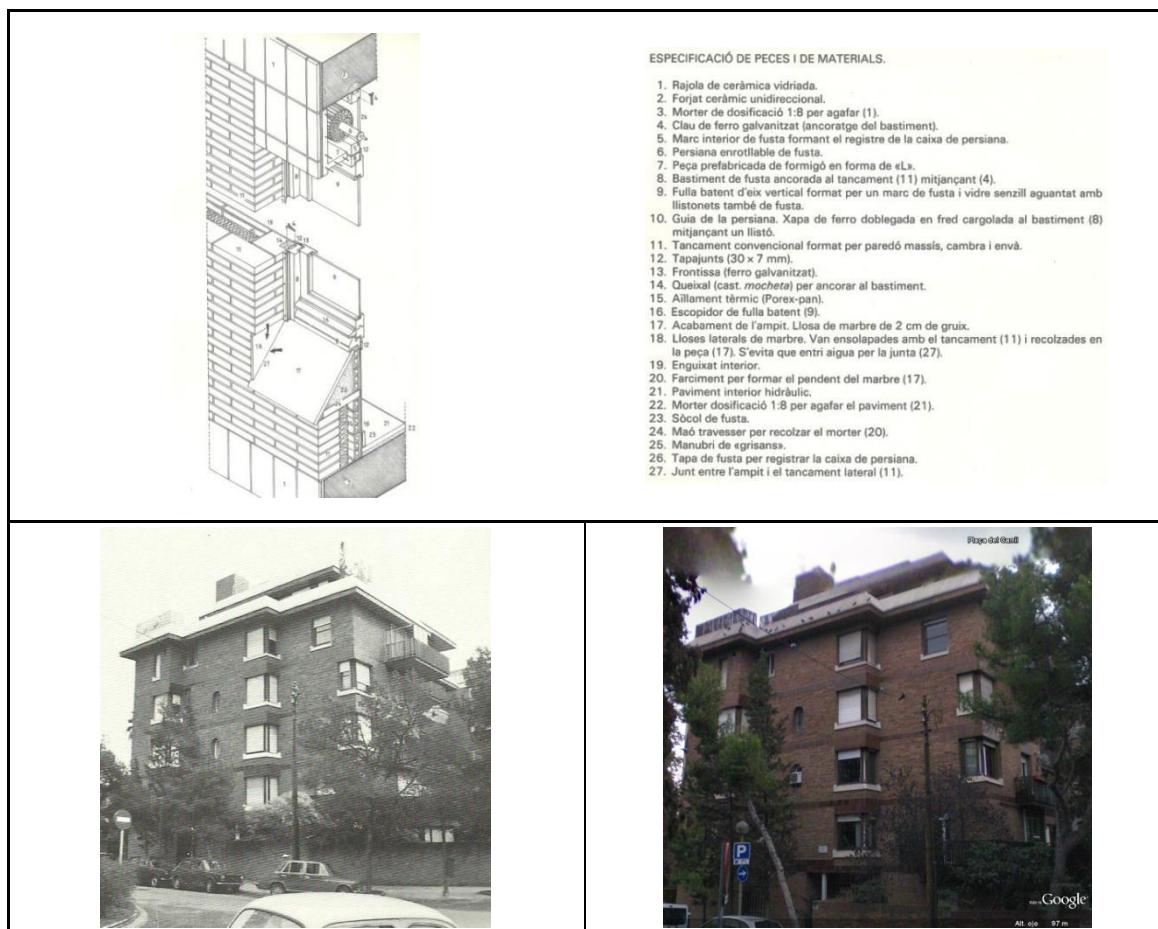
Detalle de cubierta de la edificación de Brusi 17
